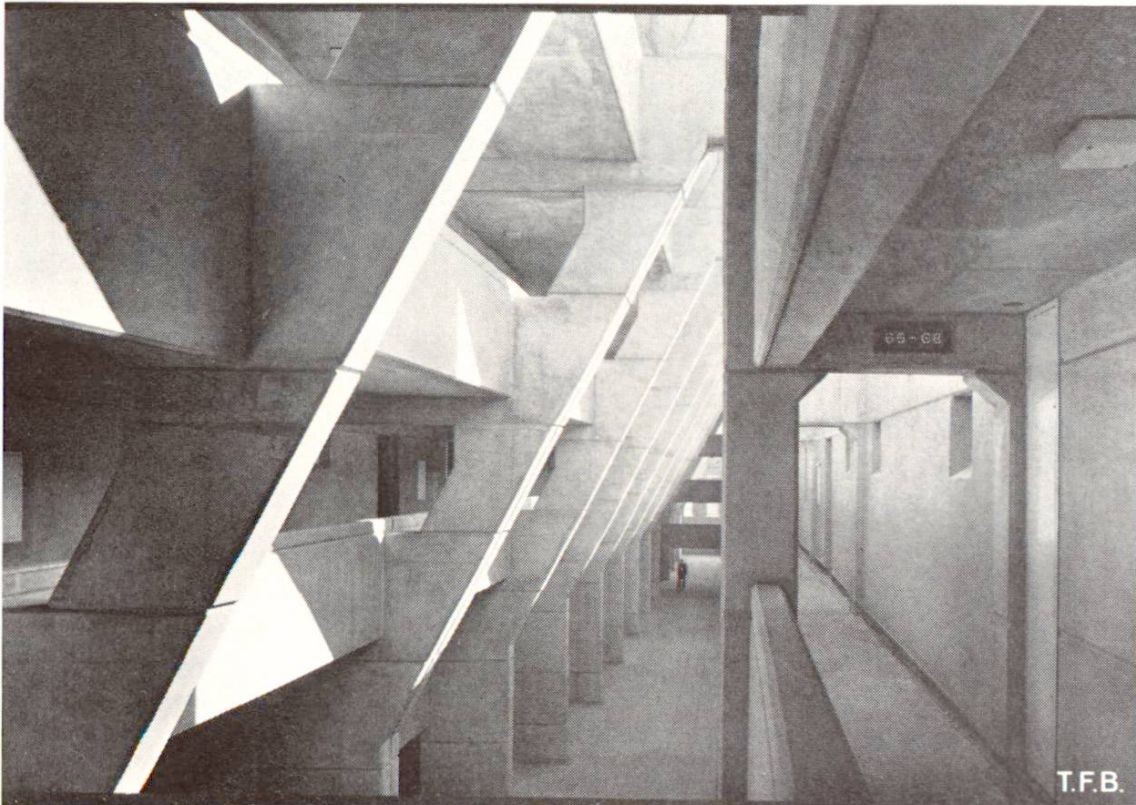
Vue sur les galeries qui conduisent aux logements, intérieurs (à gauche) et extérieurs (à droite). Squelette porteur en béton moulé sur place, dalles de sols en béton préfabriqué, parois en maçonnerie.
